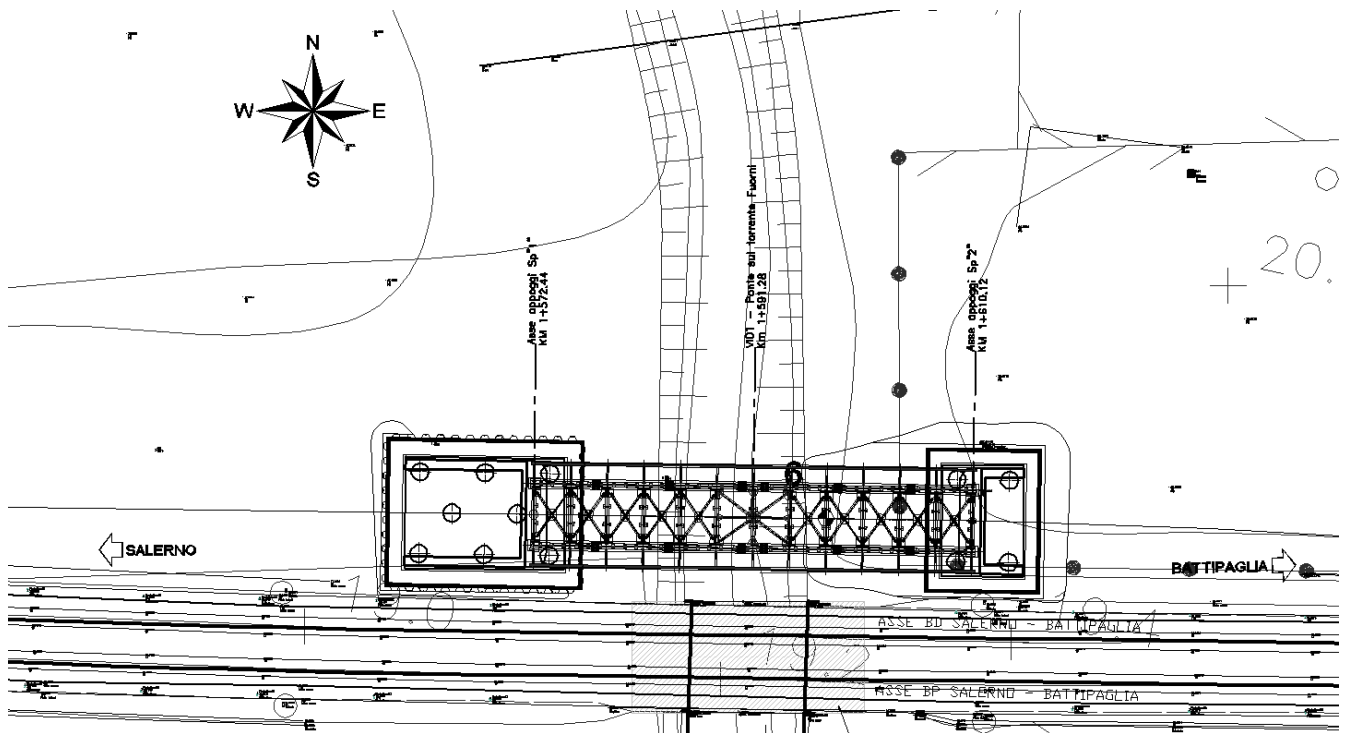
Stralcio planimetrico – ubicazione opera d'arte
